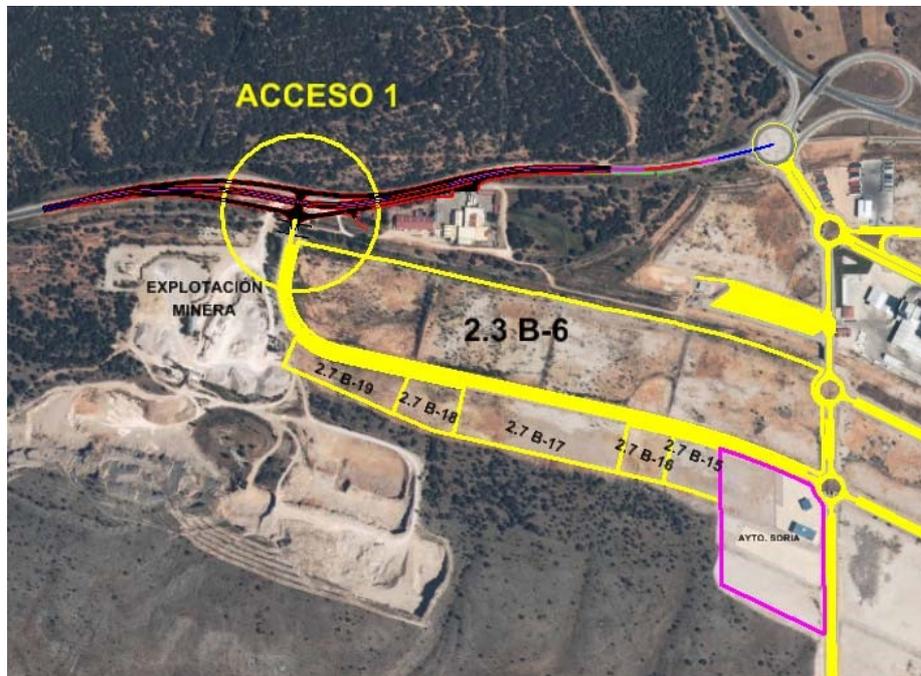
planta situación Acceso 1 con la propuesta planteada en este documento.
